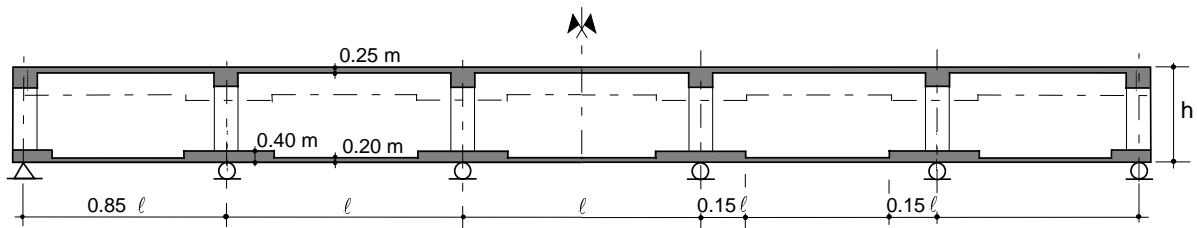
Coupe longitudinale du pont poutre routier type.
